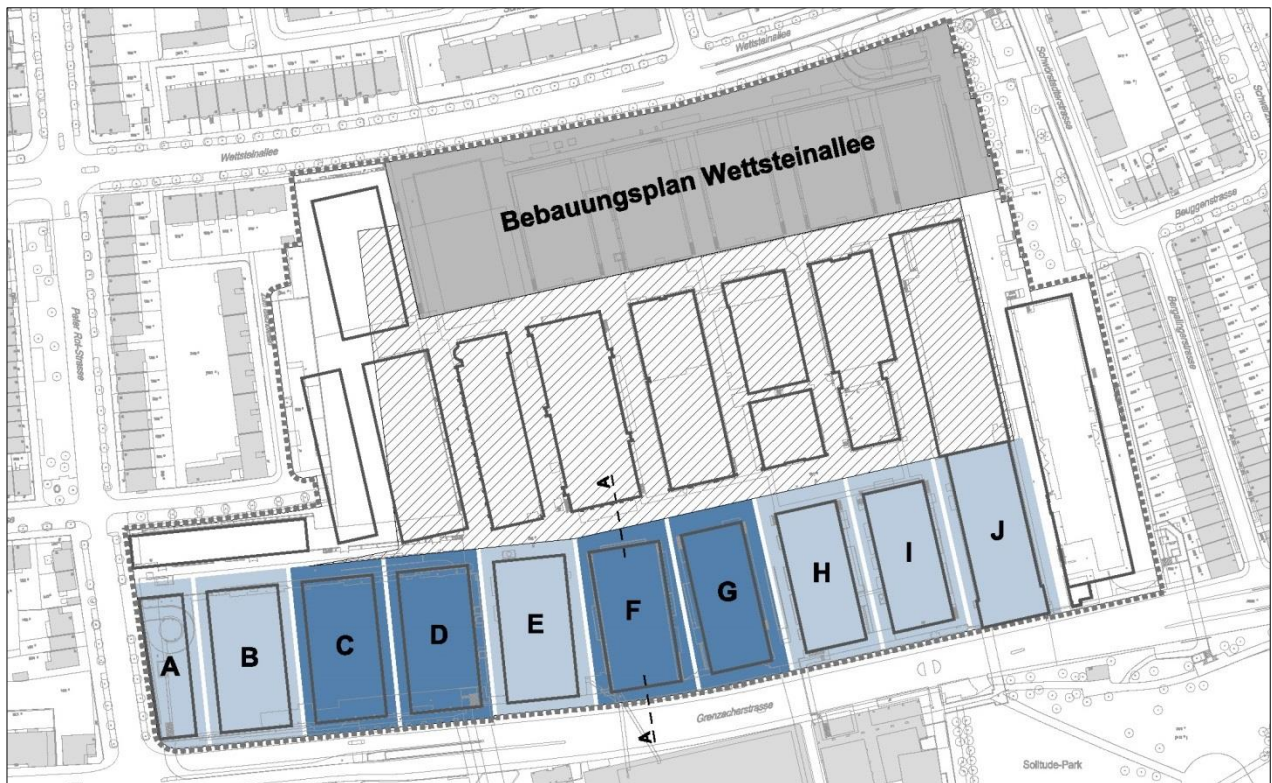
Bebauungsplan Nr. 13'871. (Kein Massstab, Plan genordet)
